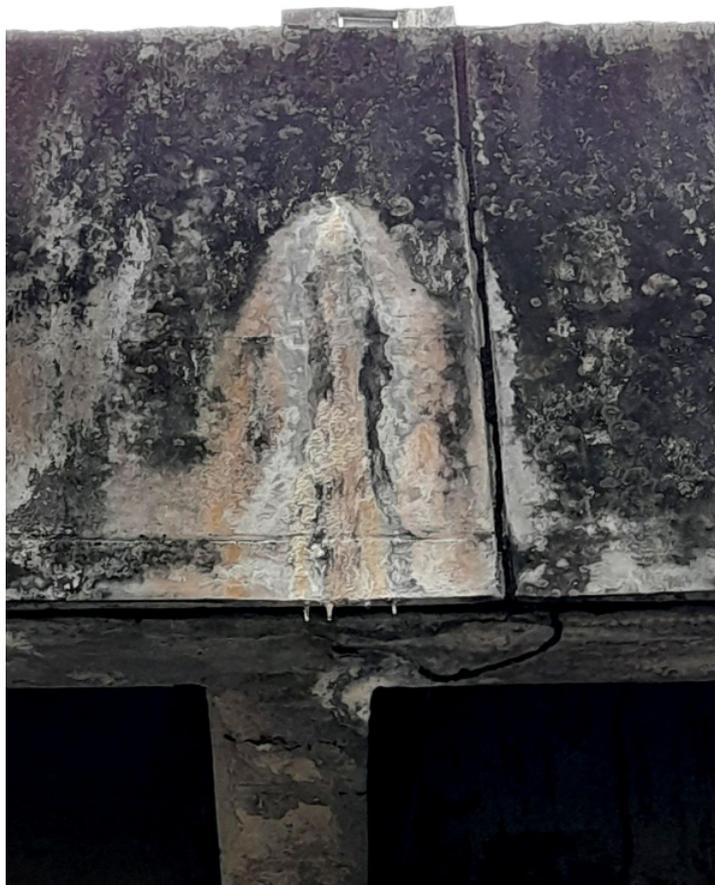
Fissuras em pilar pré-moldado
